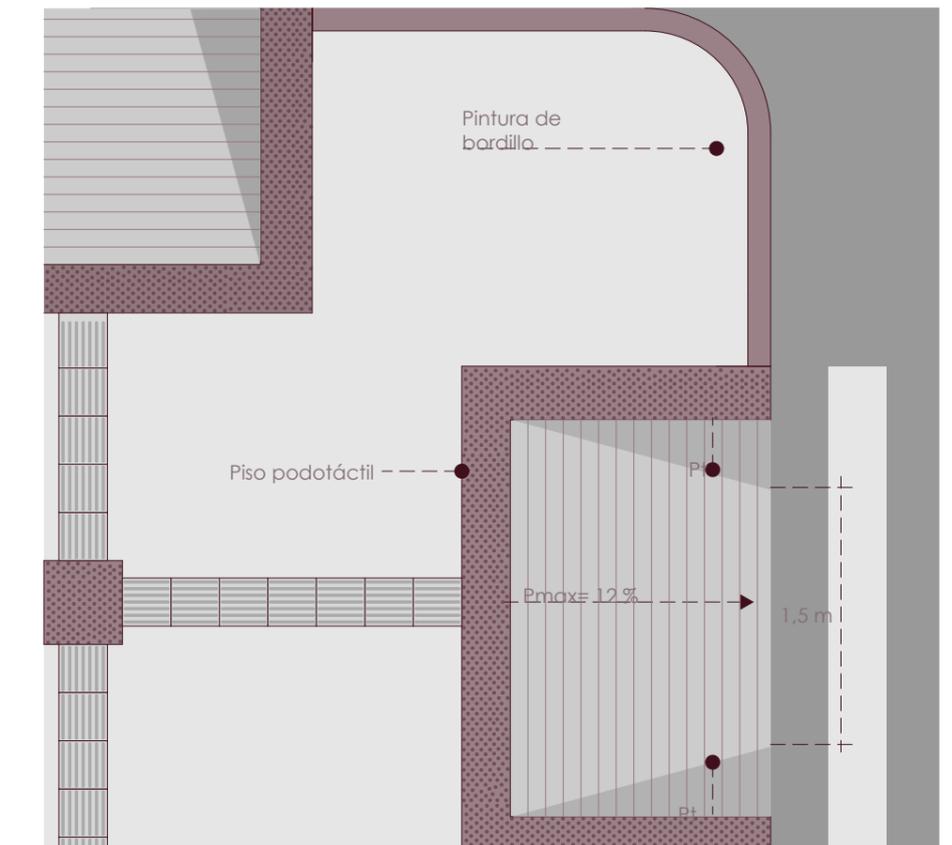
Planta - Rebaje con tres planos inclinados - Elaboración propia
